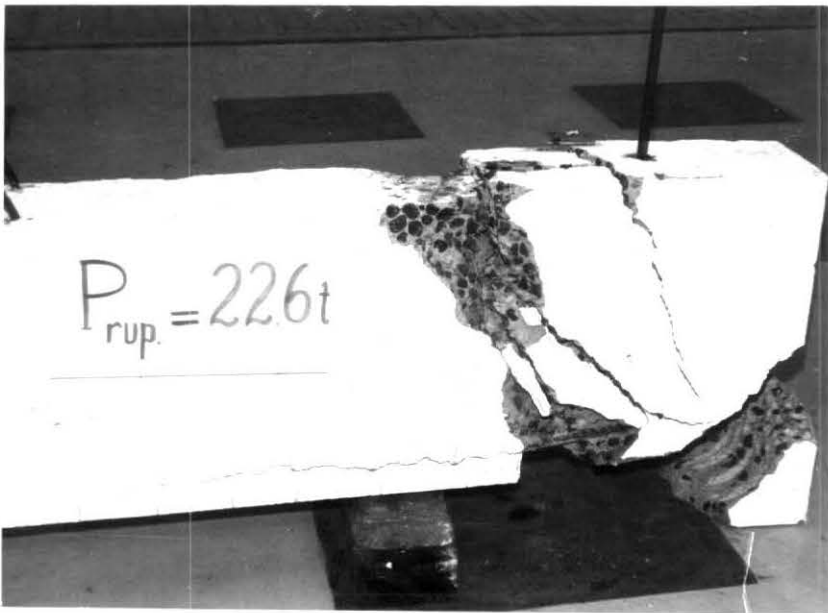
Detalhe da ruptura da viga 8B , notando-se nitidamente o esmagamento da biela de concreto.
